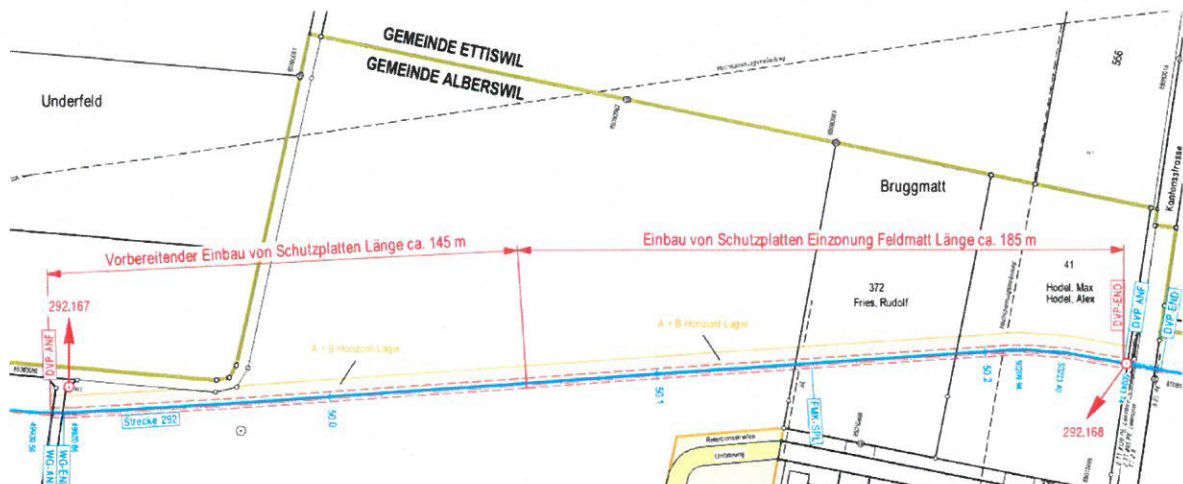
Abschnitt Gashochdruckleitung mit eingebauten Schutzplatten
